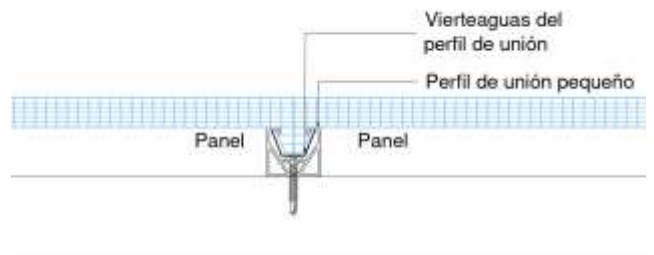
Detalle del encastre entre paneles con perfil de unión en cubierta.
